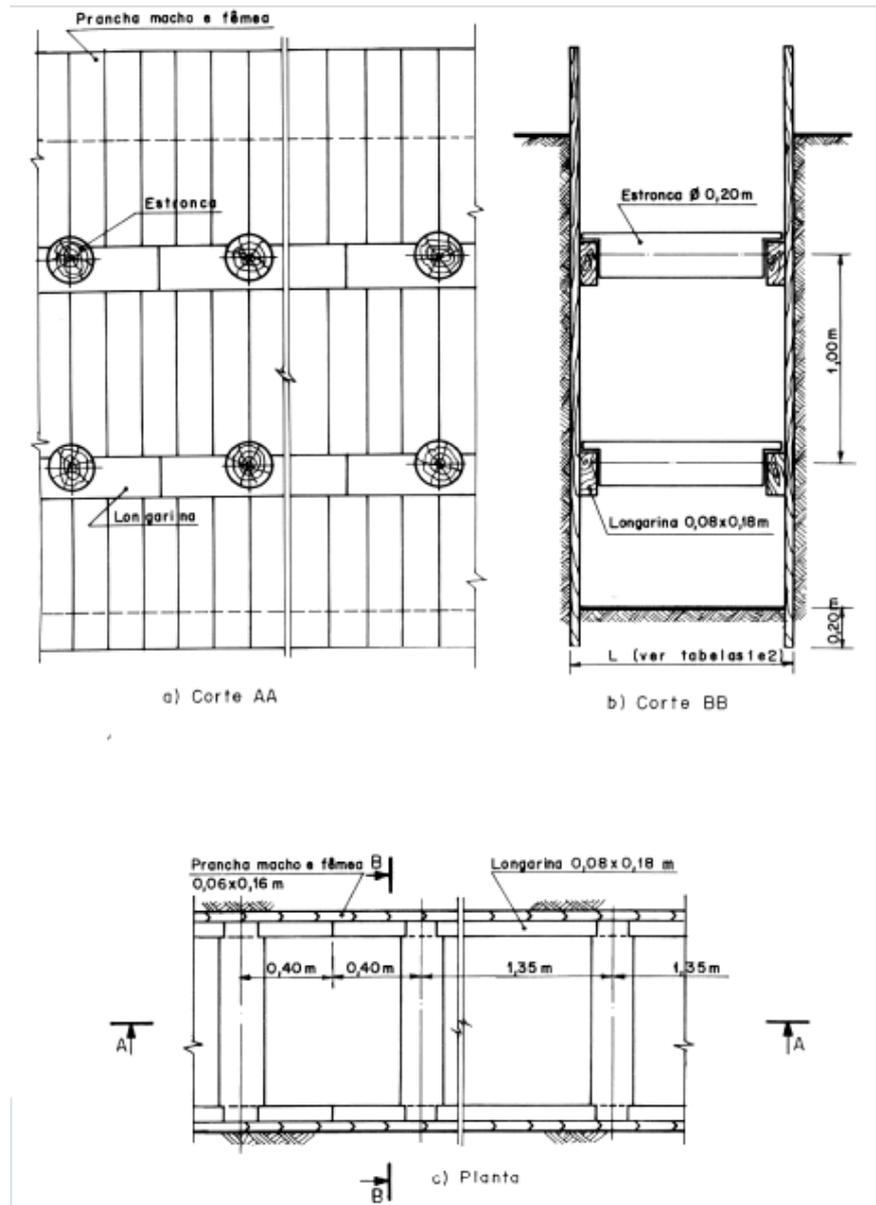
Detalhes do escoramento tipo especial, a) Corte AA, b) Corte BB, c) Planta (NBR 9814, 1987)
